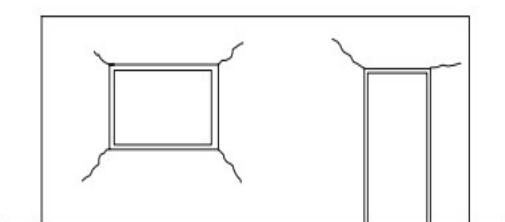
a. e b. Fissuras em Janelas dos Quartos
